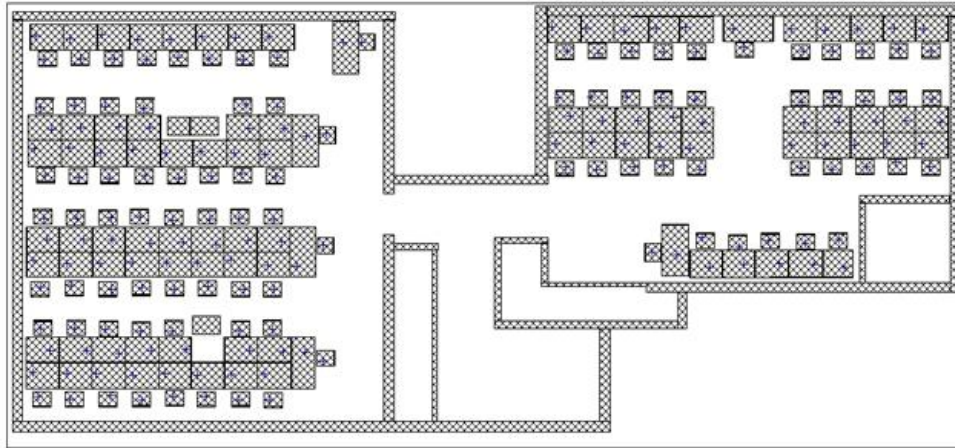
Muestra N°4. Planta e imágenes de los puestos de trabajo.
